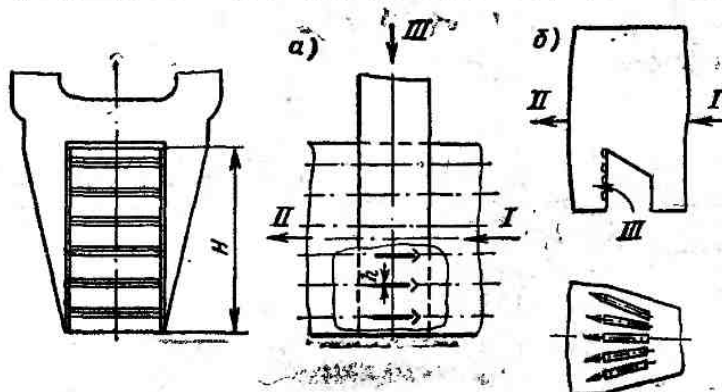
Схемы устройств для смешения рециркулирующего воздуха с холодным
